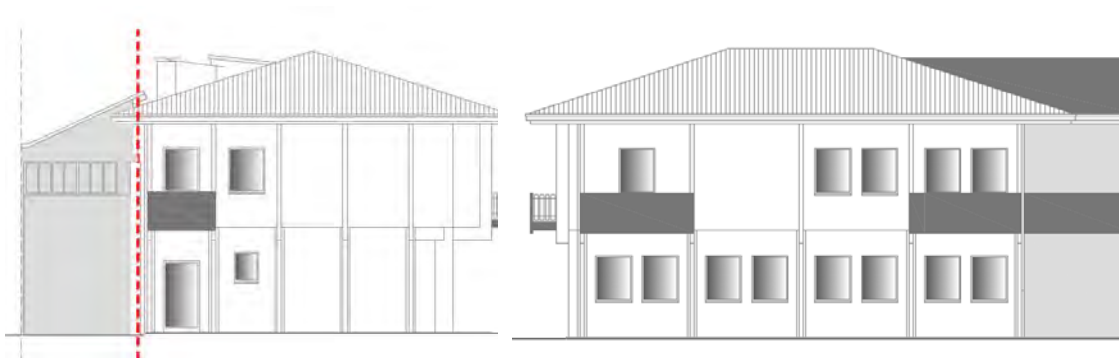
prospetto eseguito con AutoCAD del progetto
